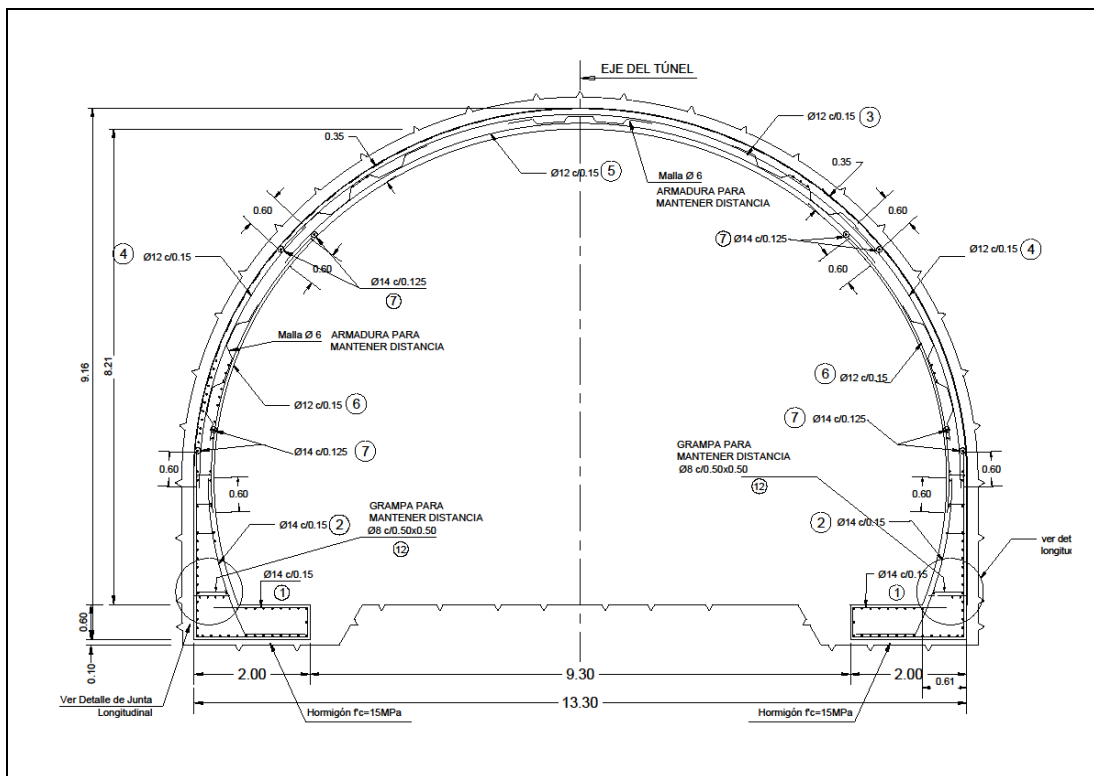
Sección transversal del túnel San Eduardo en roca clase I.
